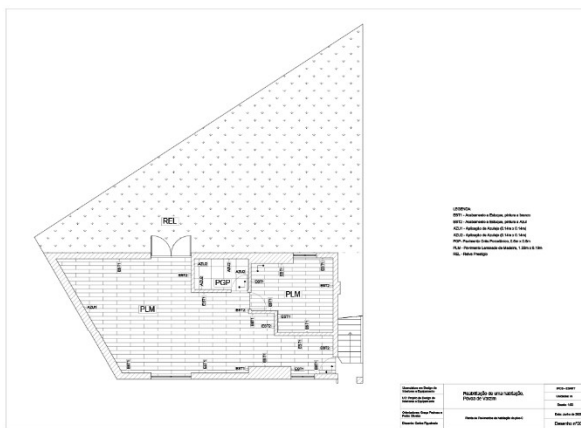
Planta de Pavimentos Habitação Piso 0. Fonte: Autor.
